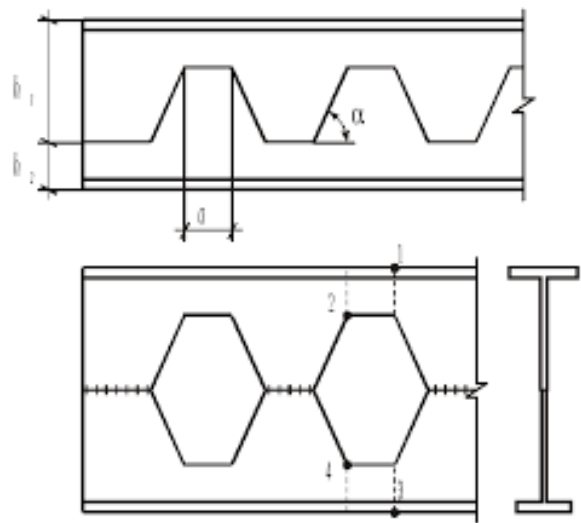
Загальний вигляд і схема формоутворення балки з перфорованою стінкою
